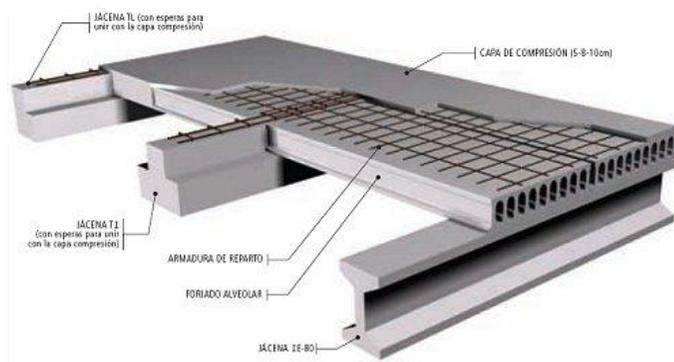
Esquema de entresque con losa alveolar y estructura soportante de hormigón.
